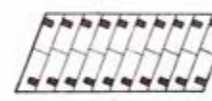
Casette singole, a fila doppia, inclinate rispetto alla strada.
